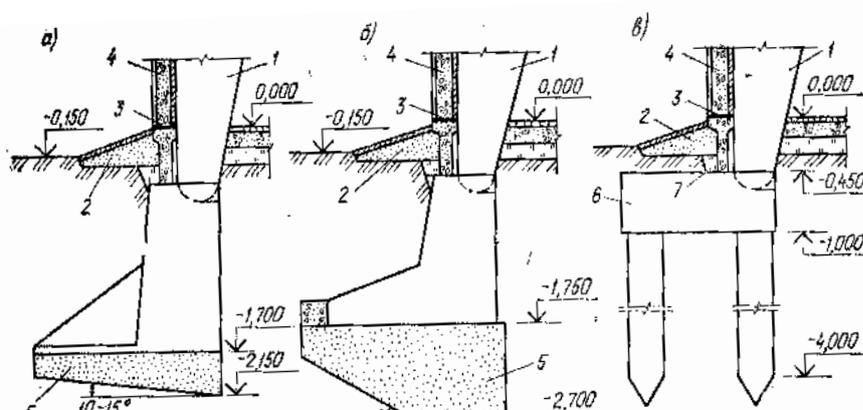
Конструкции фундаментов под несущие распорные конструкции:
